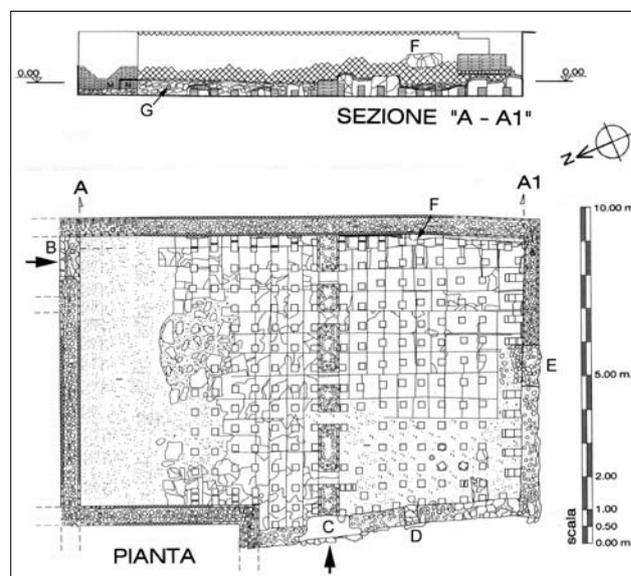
Pianta e sezione dell'ambiente con vespaio situato fra le terme e il macellum (L. Ciriello).
